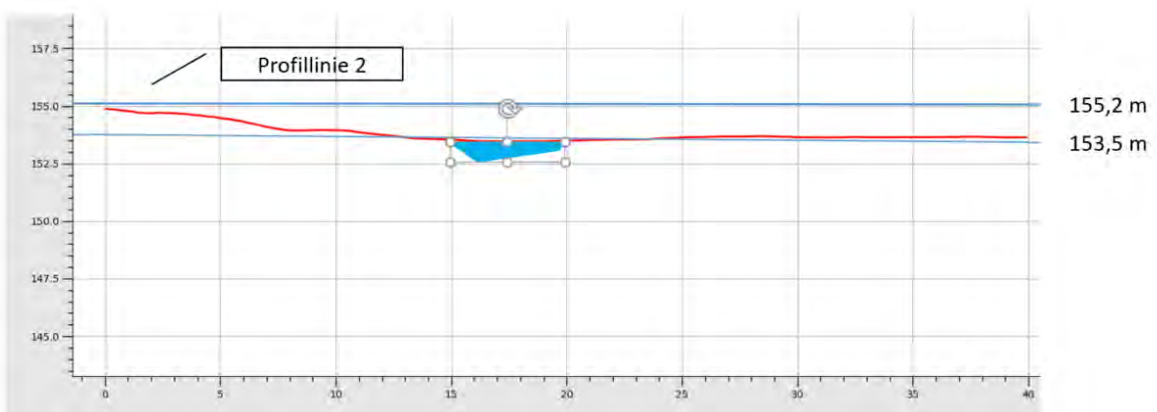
Profilschnitt nach Vermessung 10.10.2022 und geplante keilförmige Vertiefung
